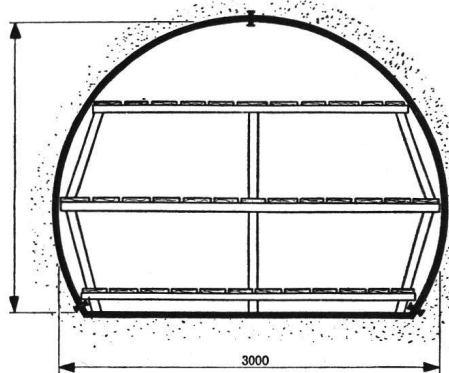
Tunnelunterstand mit Holzbau ohne Durchgang.
